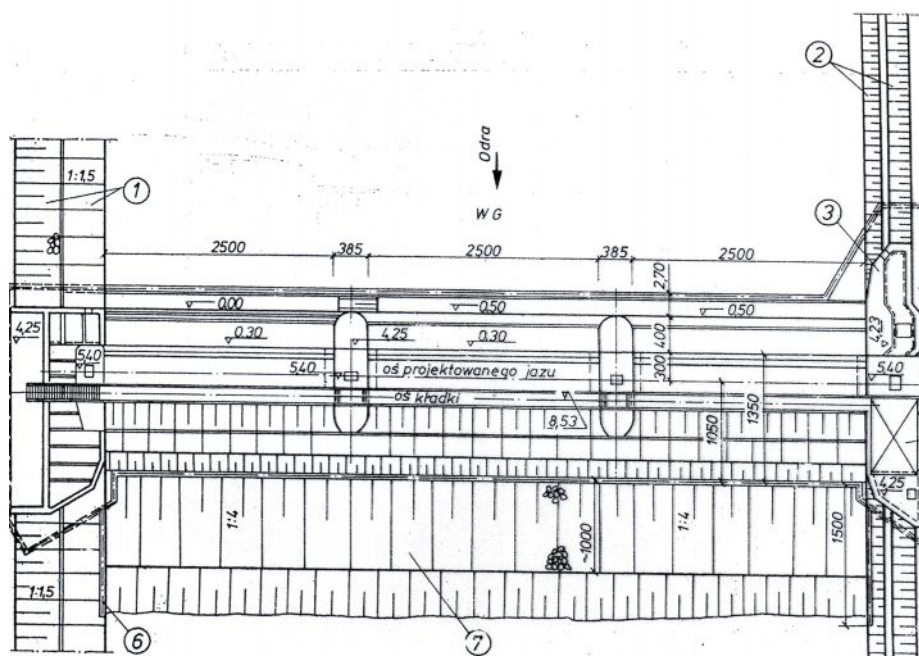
Przekrój poprzeczny konstrukcji jazu z zamknięciem segmentowym (projekt)
